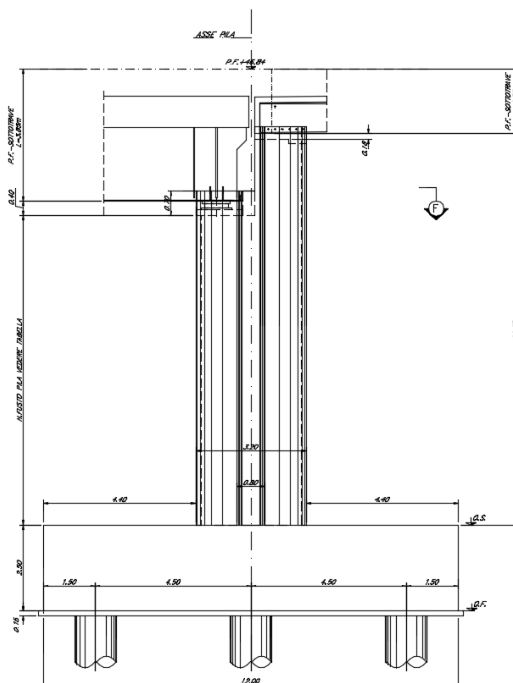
Prospetto Pila P8 -sezione longitudinale
